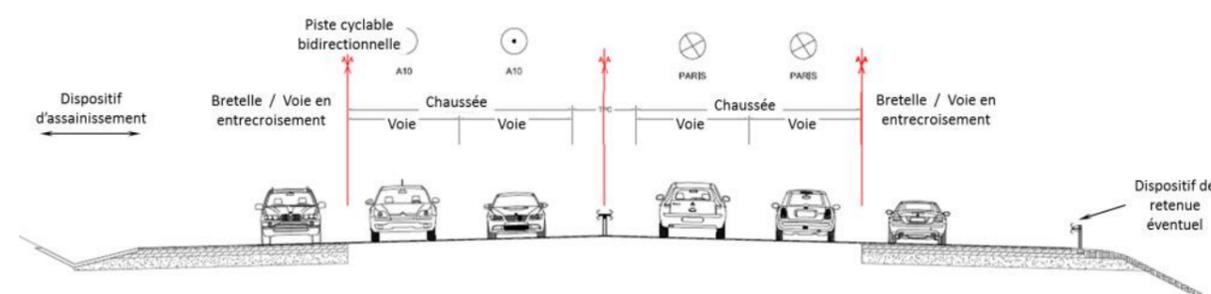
Profil en travers type mis en œuvre sur la section courante (RN 118) au droit de l'insertion des bretelles.
